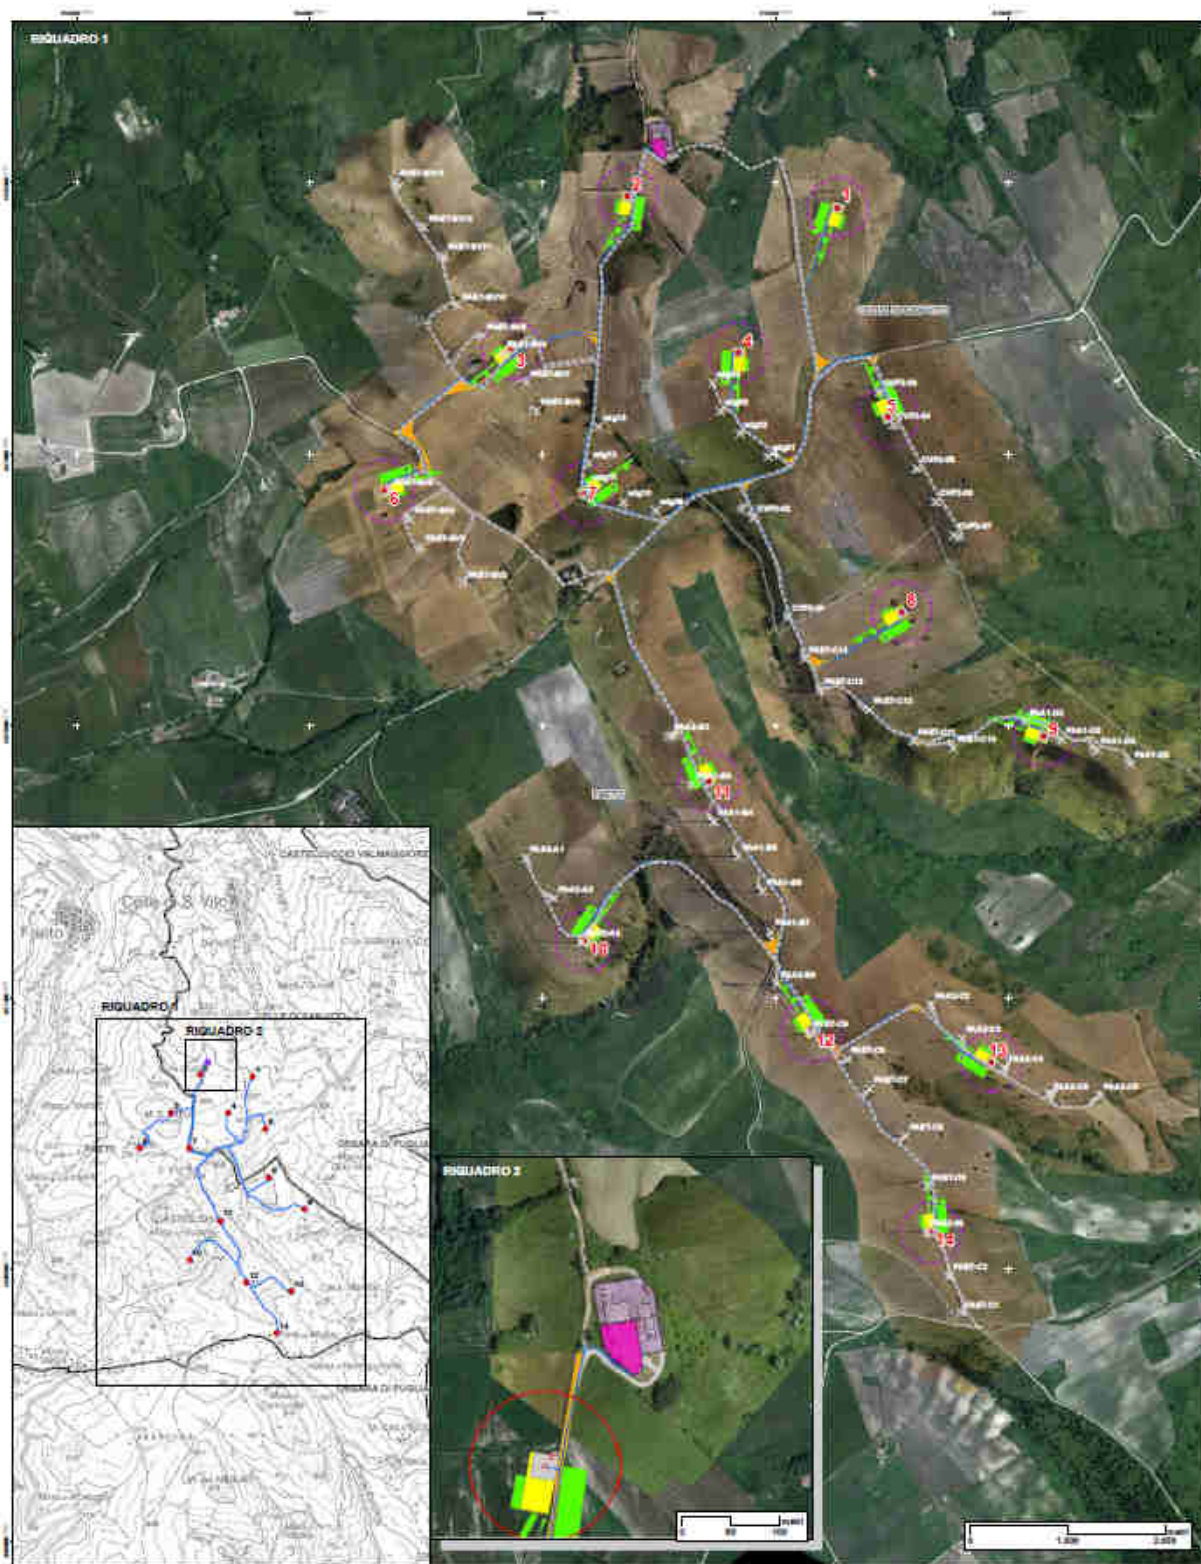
Ortofoto drone (Luglio 2023): Planimetria generale - VIA\_02\_R2P8522\_Planimetria di progetto su ortofoto.
